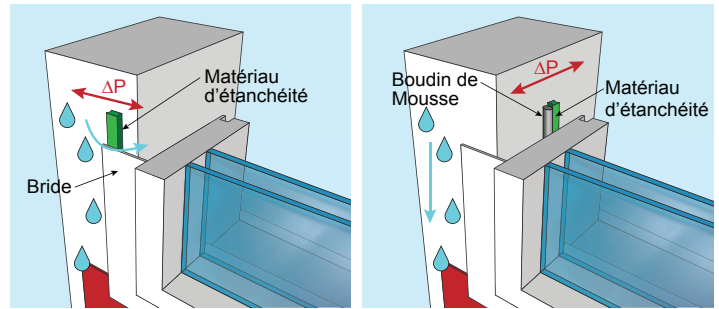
Détail d'un montant de fenêtre montrant : (a) que le matériau d'étanchéité placé à l'arrière de la bride déplace le plan d'étanchéité à l'air vers l'extérieur du mur, où l'eau pourra s'exfiltrer par les petites imperfections; (b) que le déplacement du plan d'étanchéité à l'air vers l'intérieur réduit la force d'entraînement qui permet à l'eau de s'infiltrer au niveau de la bride.
